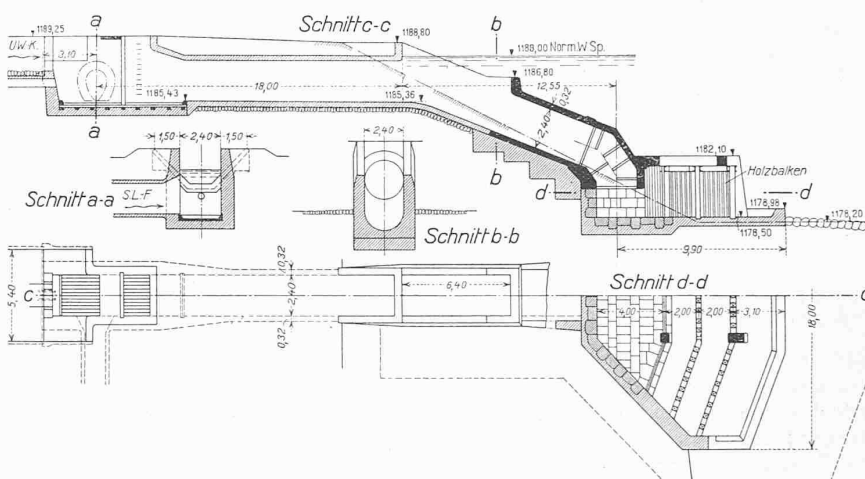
Einlauf- und Energievernichtungs-Bauwerk im Grundwasser- und Ausgleichbecken Aeuja oberhalb Klosters. — Grundriss und Schnitte 1:400.
